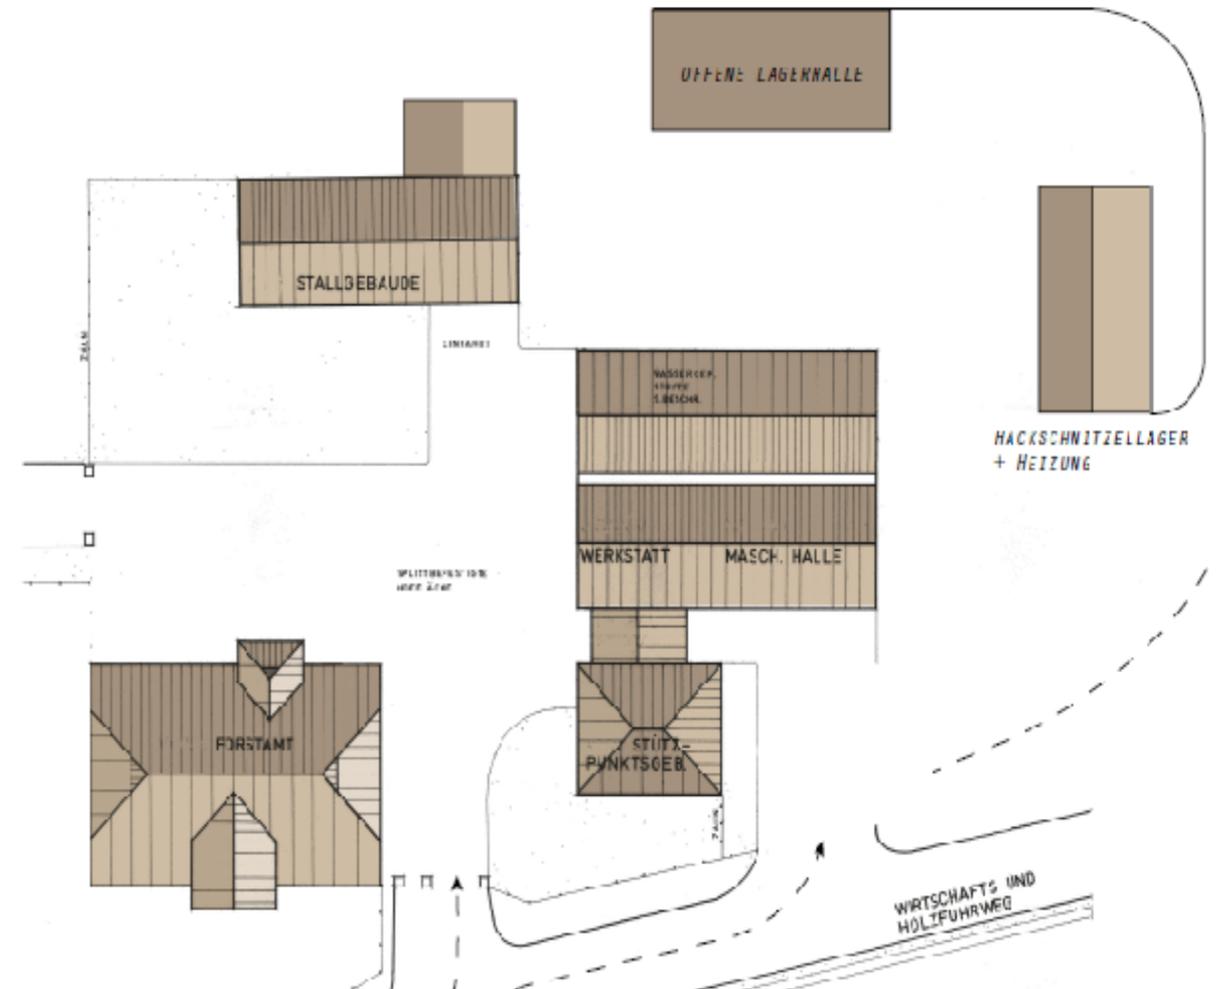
Forstamt Soonwald-D / Lageplan
